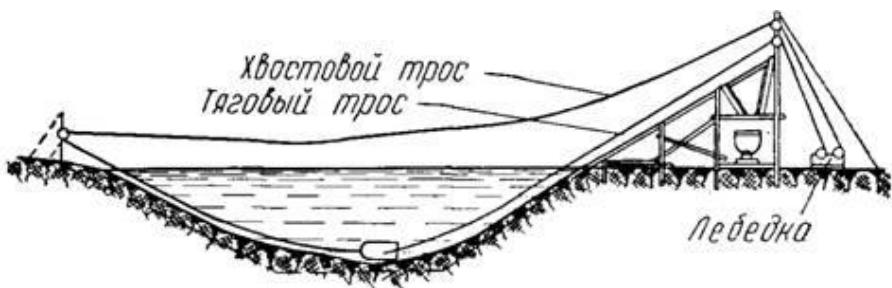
Береговое устройство для протаскивания трубопровода
